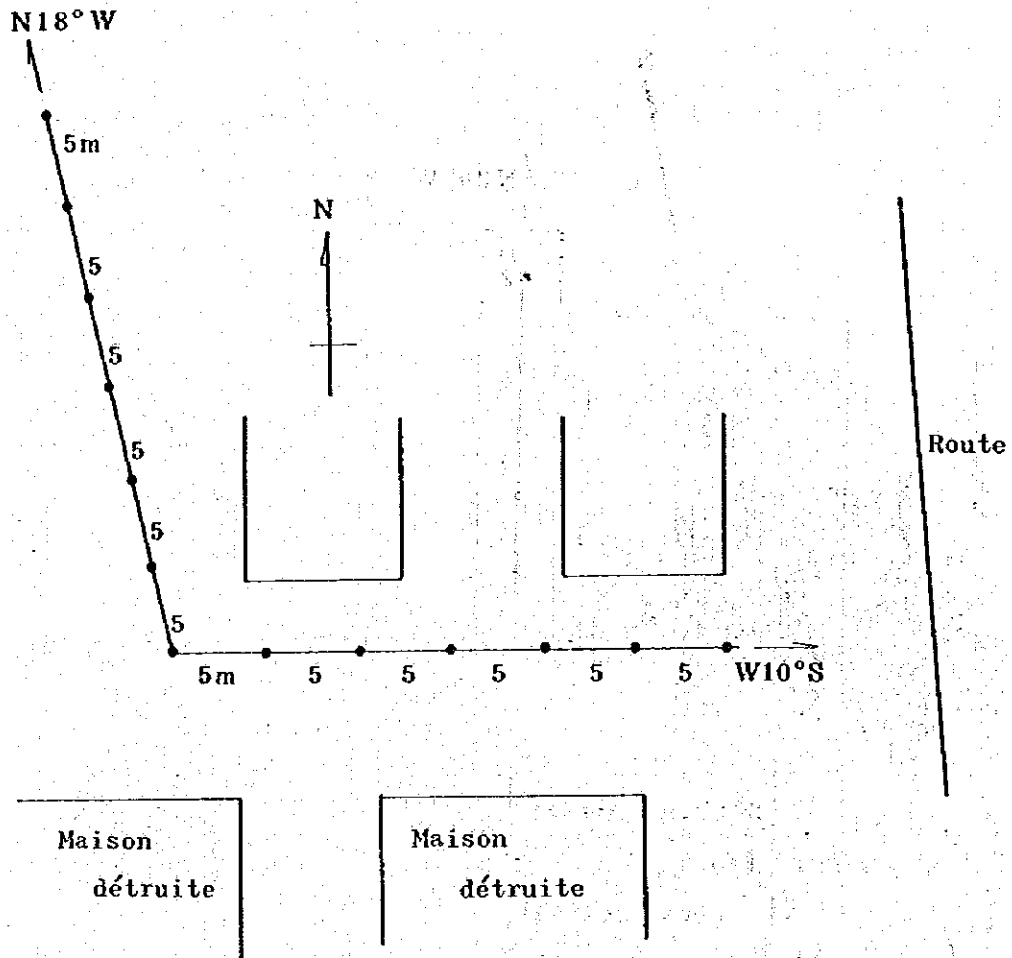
Ligne de mesure du grand ensemble (N° 3)
